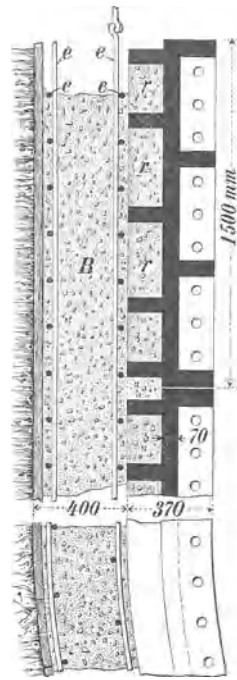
Kúvelage in Verbindung mit Eisenbeton für besonders hohe Drücke.
